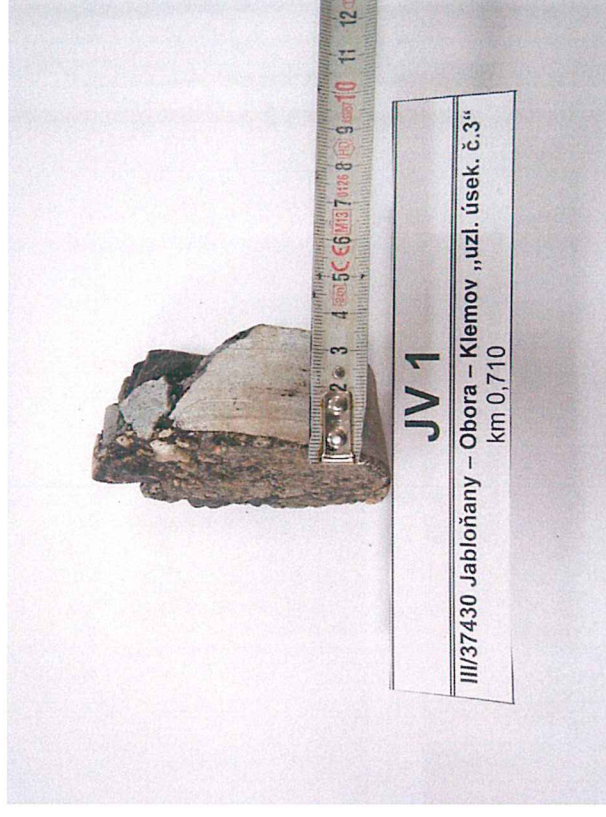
Detail vývrtnu JV 1 (úsek č.3)
